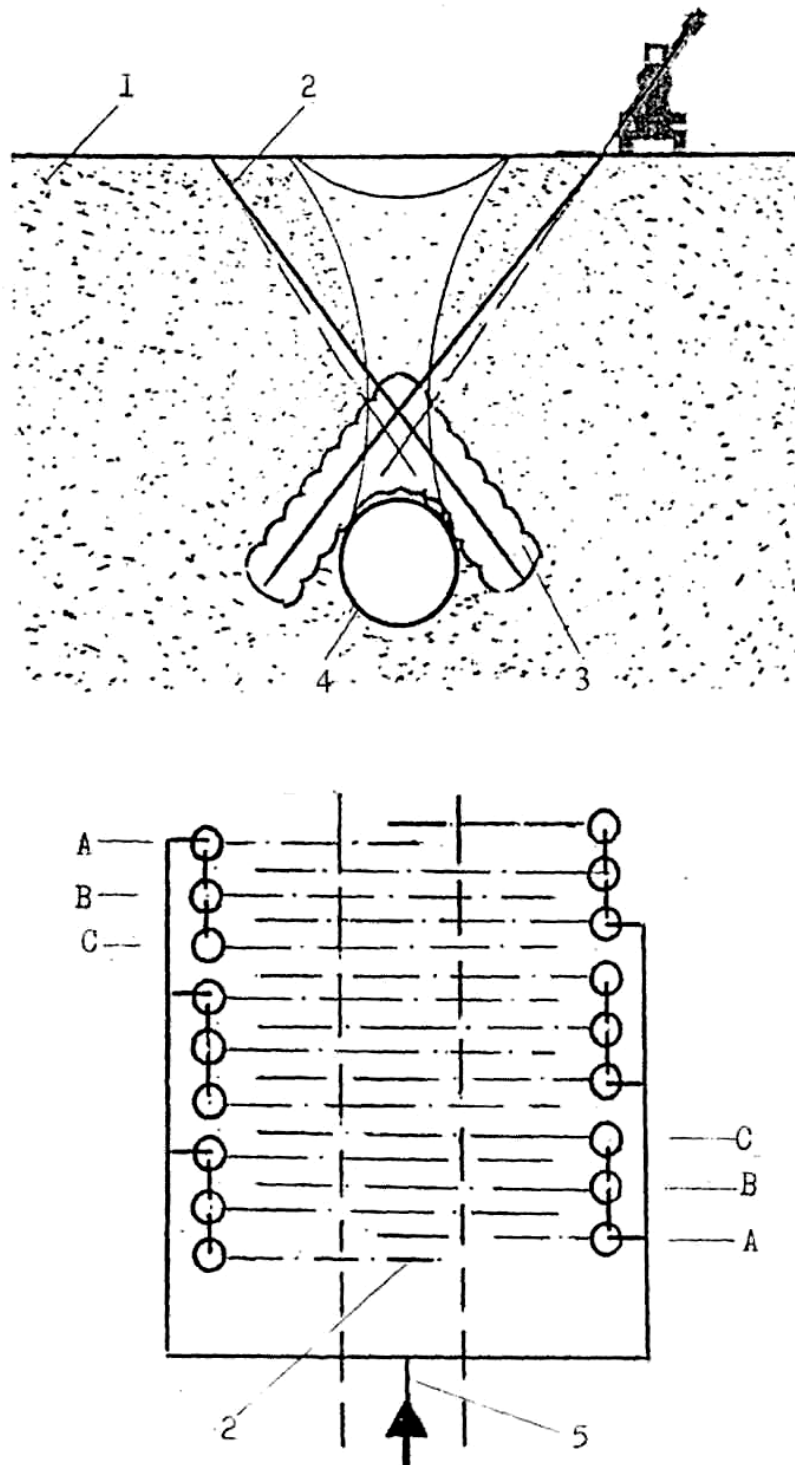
Схема льдогрунтового ограждения вокруг локального обрушения свода тоннельной обделки:
